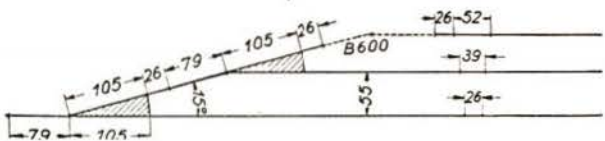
Weichenstraße mit zwei Parallelgleisen bei normalem Gleisabstand; Maßstab 1:10. Wie Bild 2, aber statt B 600 + 2 Stück G 1/8 werden verwendet: 1 Stück RW + G 1/8
